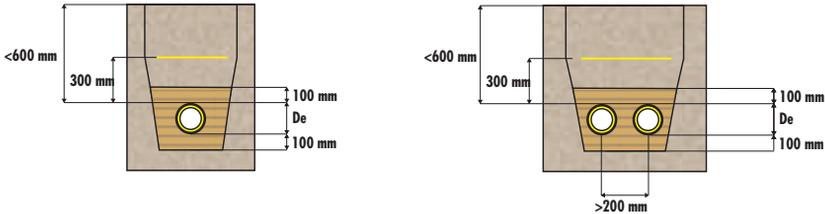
Tubazioni interrate con profondità di scavo inferiore a 600 mm sopra il tubo
